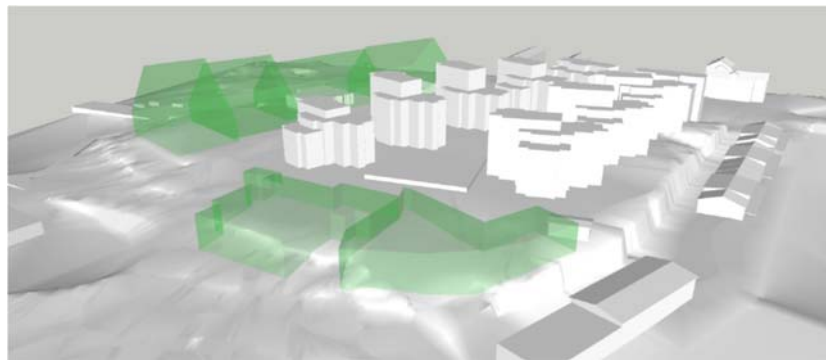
Maximal byggrätt enligt gällande detaljplan.
